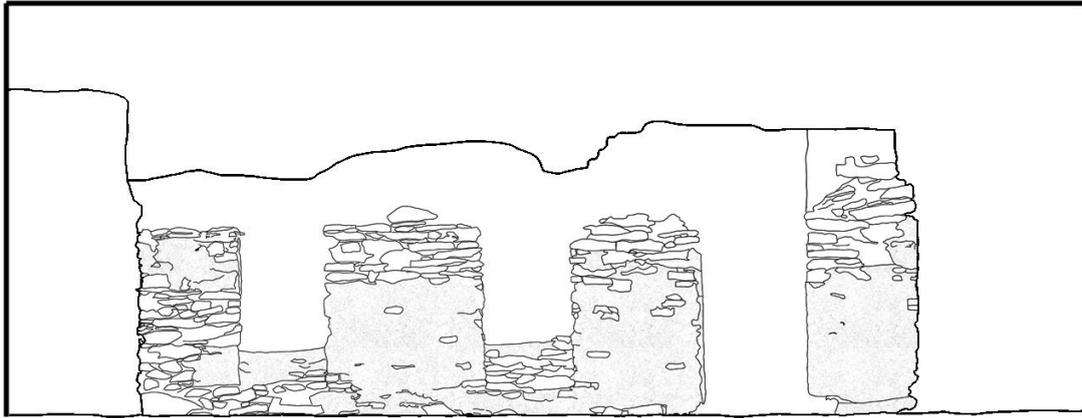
Andriani Mario. prospetto nord-ovest - edificio di servizio
